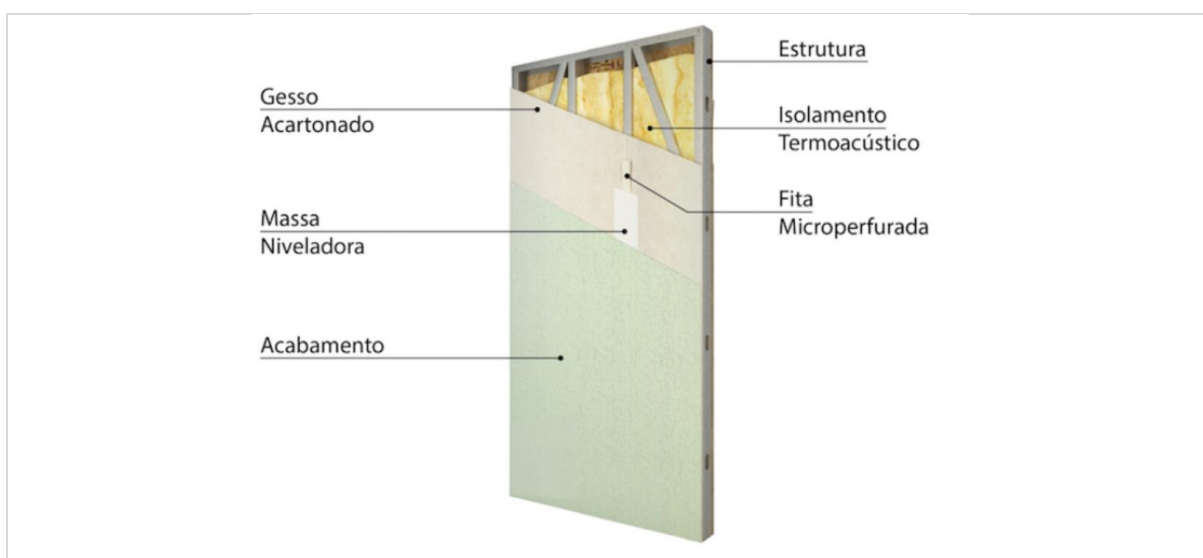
Fechamento da face externa de uma parede em Steel Frame
